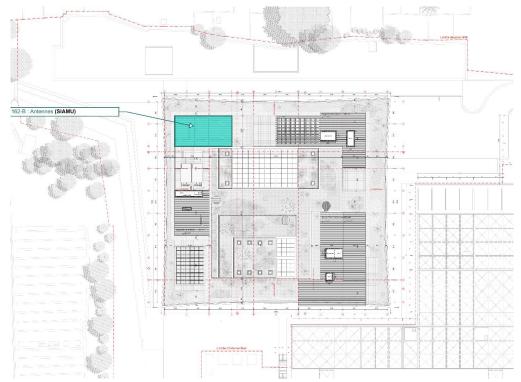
Installations classées visées par le SIAMU – Niveau +8 (toiture) – rubrique 162B
